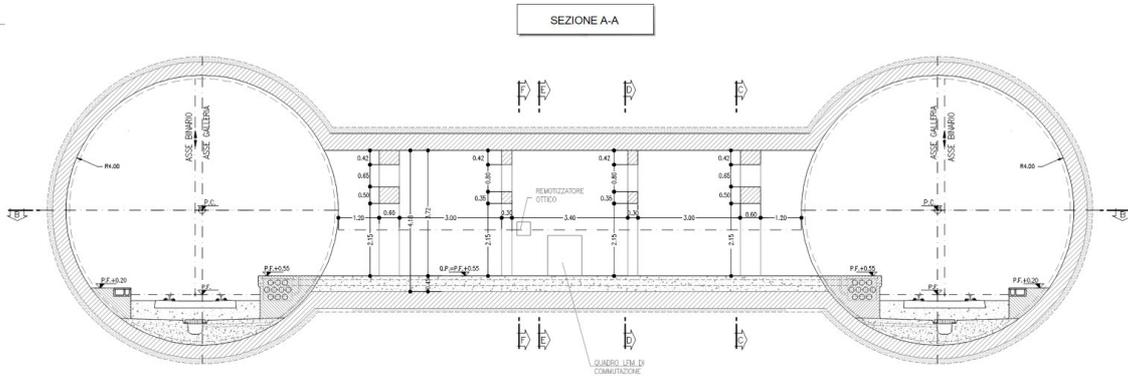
Collegamento trasversale di esodo (scavo meccanizzato)
